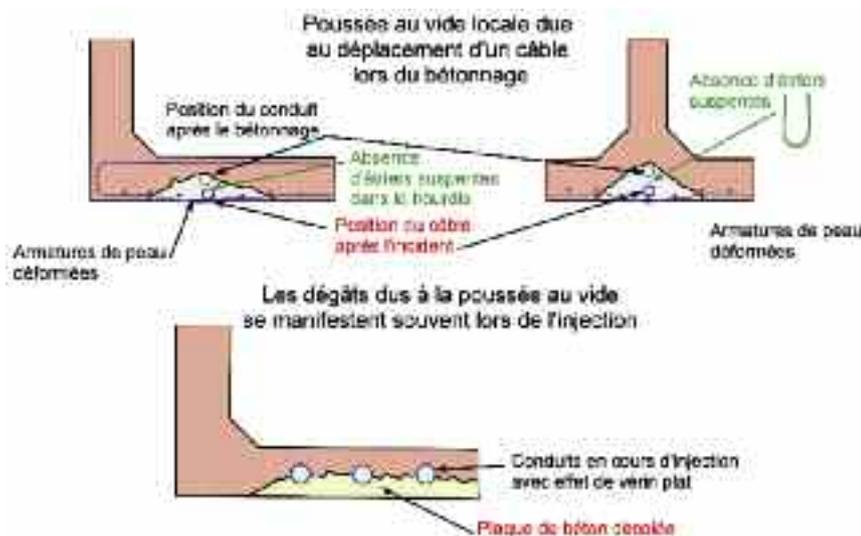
poussée au vide locale due à une cassure du tracé des conduits
